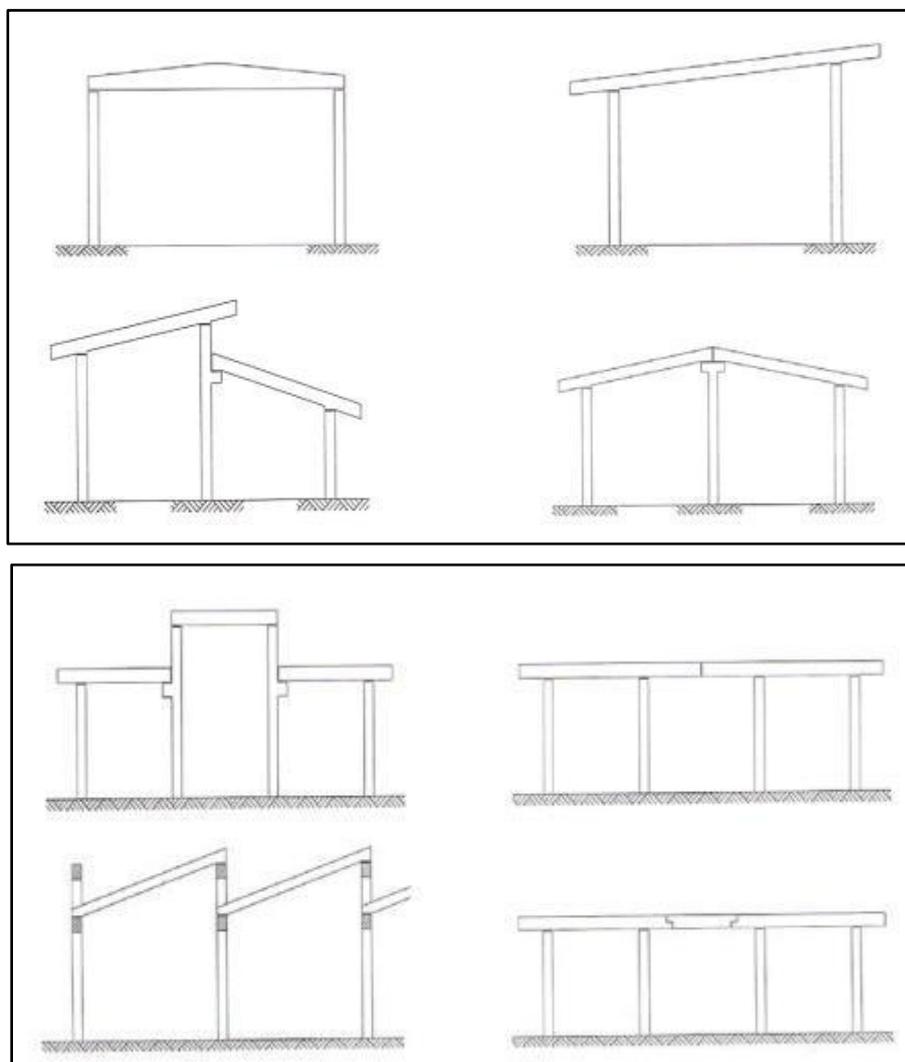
Com ligação rígida entre pilares e elementos de cobertura
